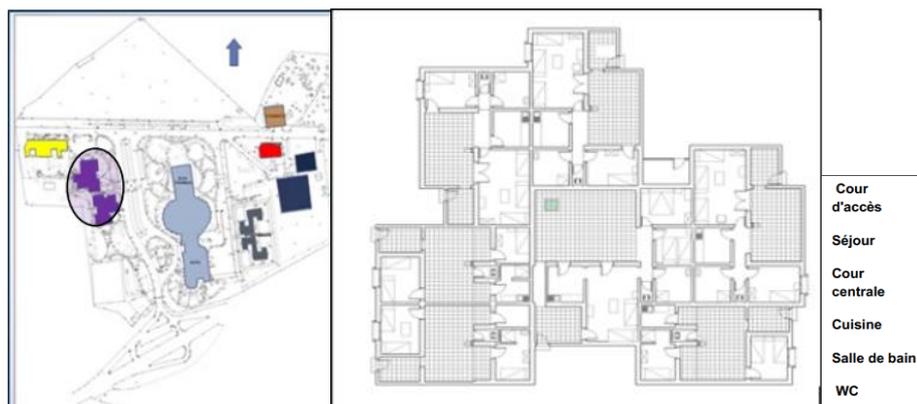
51: Plan type des bungalows (google image modifier par l'auteur 2019)
